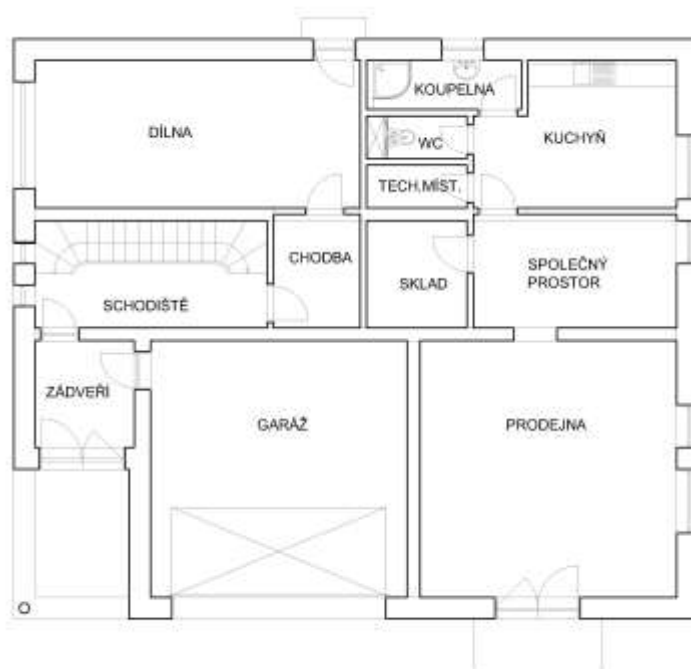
stavební objekt pro praktickou část [autorka]
